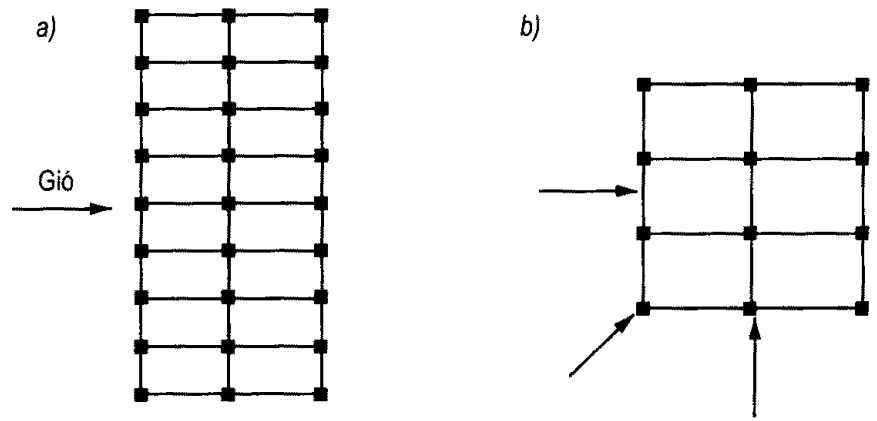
Các trường hợp hệ khung chịu tải trọng ngang
